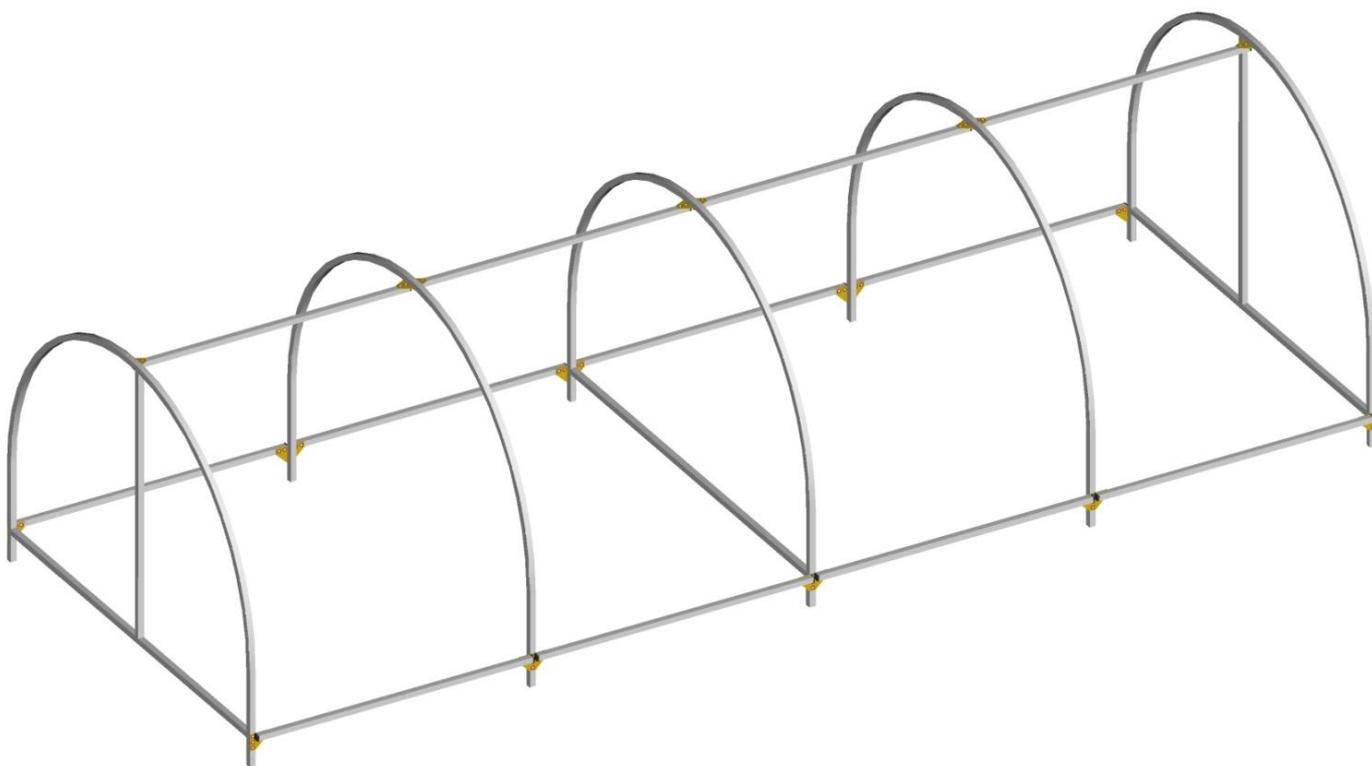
Сборка каркаса для мини-парника размером 4х1,5 м (базовый и доборный комплекты).
